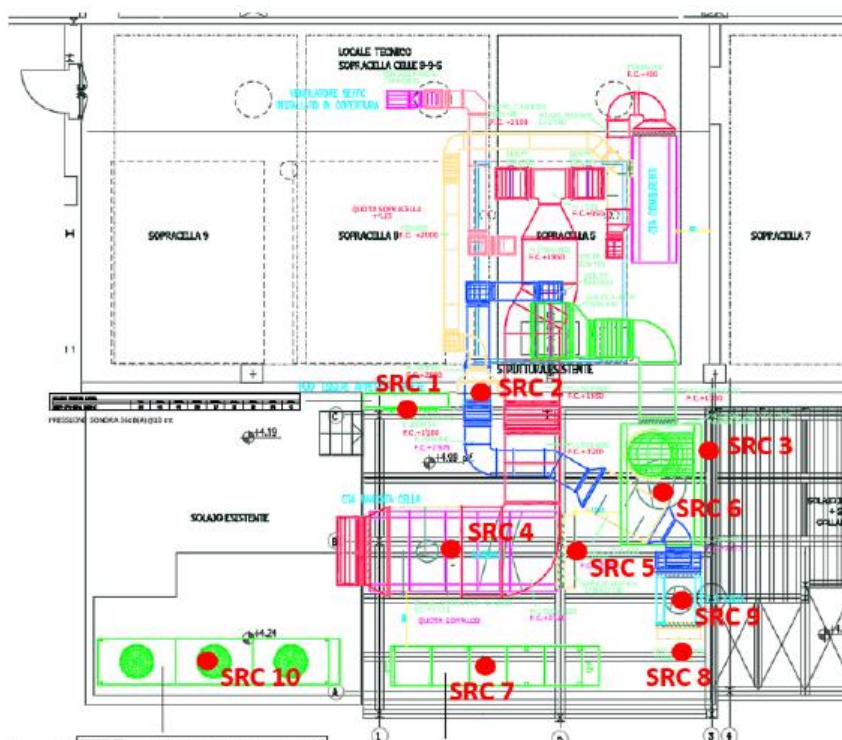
Estratto della relazione (Doc.B - Pag.6) con indicazione della posizione delle sorgenti di progetto
